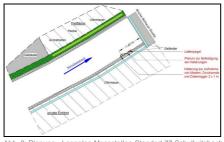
Planung - Lageplan Messstellen-Standort 77 Schullwitzbach,
